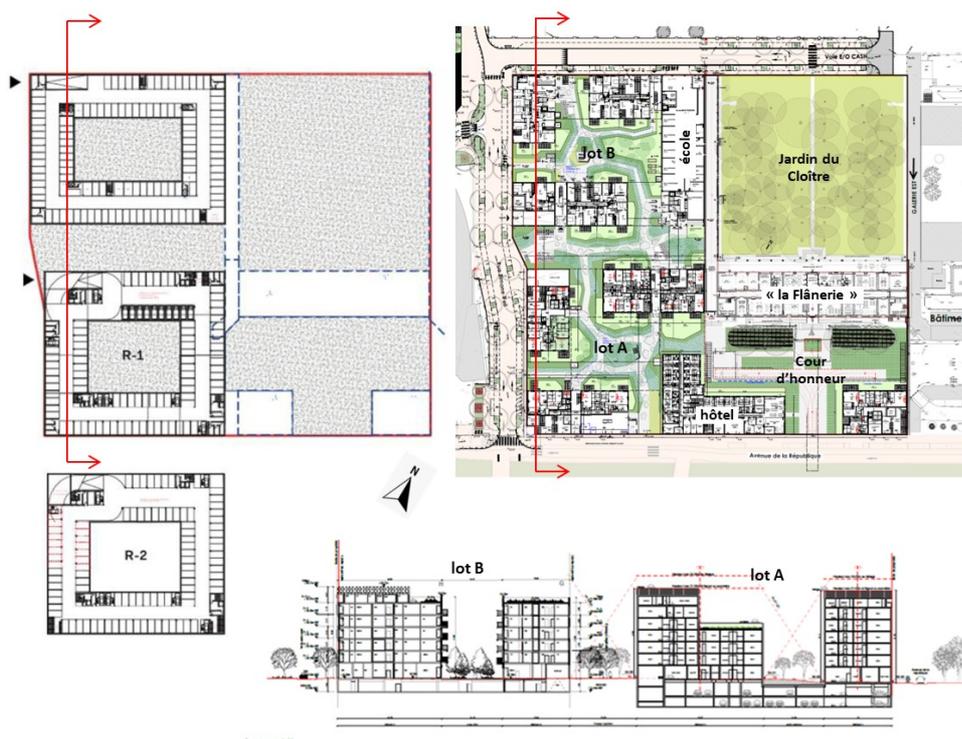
Plan des sous-sols, du rez-de-jardin et coupe nord-sud (périmètre « socle »), source : étude d'impact, p. 207 (plans des sous-sols), permis de construire (plan du rez-de-chaussée et coupe), avec indications de la MRAe.
